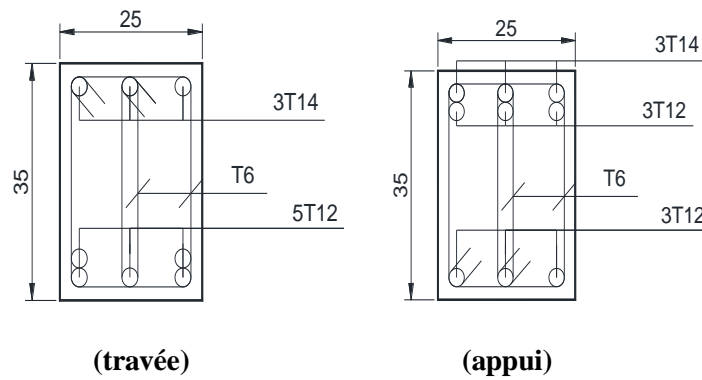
Coupe longitudinale d'une poutre principale 25x35cm (plan irrégulier en élévation)
